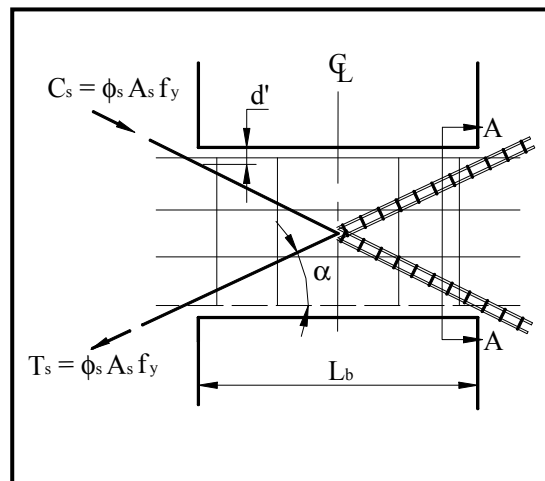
Poutres de couplage - disposition diagonale de l'armature principale
